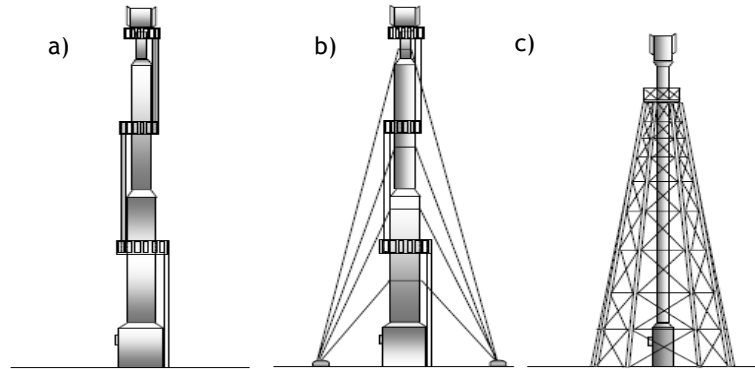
Tipos de estruturas para Flares com elevação - a) Suporte de Self, b) Suporte de Guy e c) Suporte de Derrick (Charles e Baukal, 2001).
